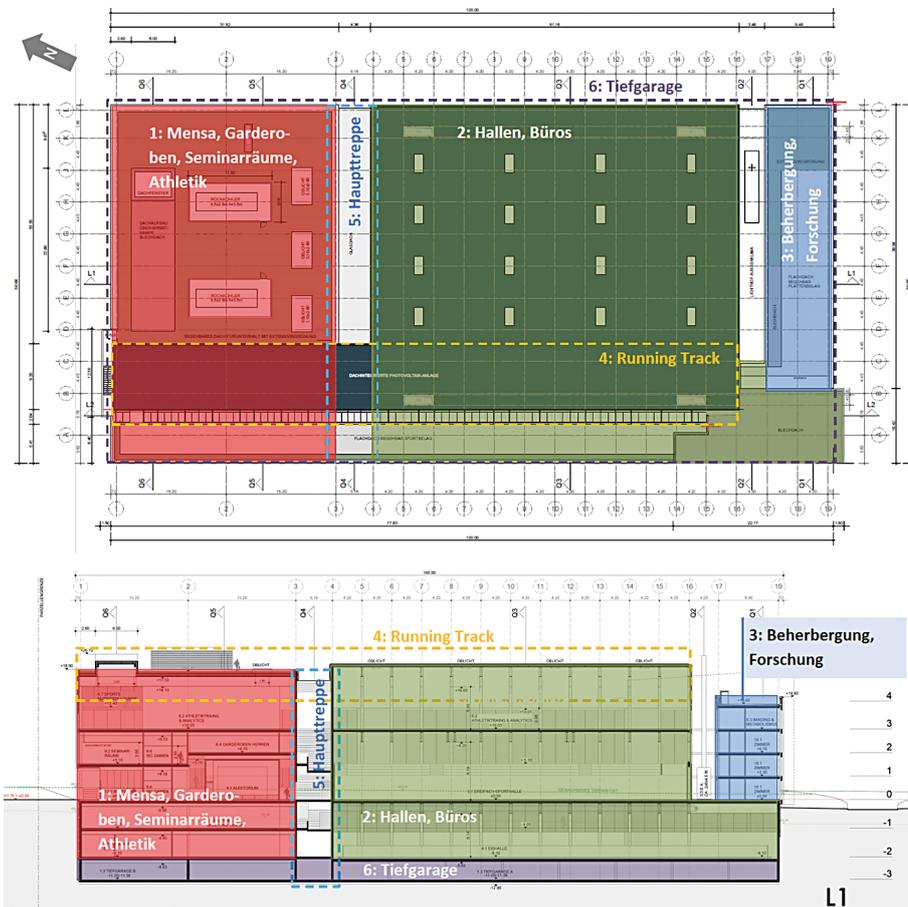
Übersicht über die funktionale Gliederung (Grundriss und Schnitt)
